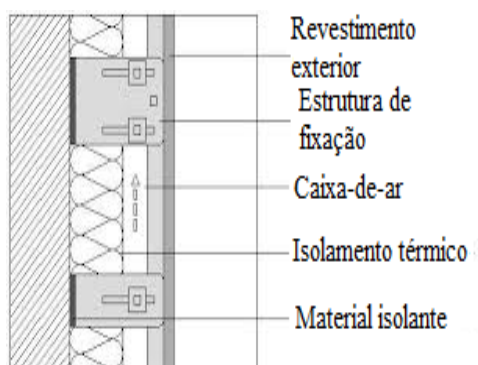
Pormenor construtivo fachada ventilada (Adaptado de [28])
